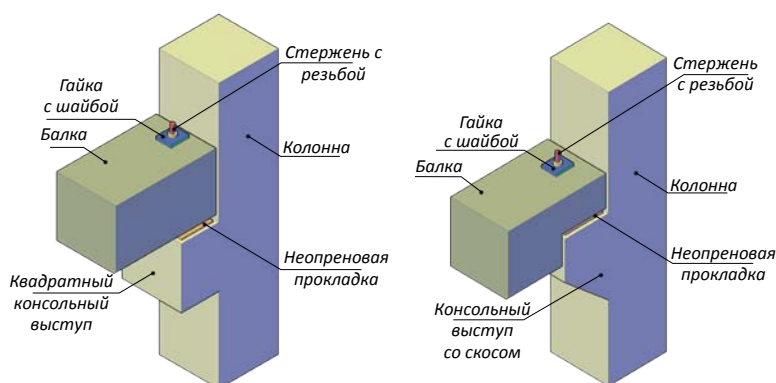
Опираие балки на консоль и опираие на высоте сечения балки.
